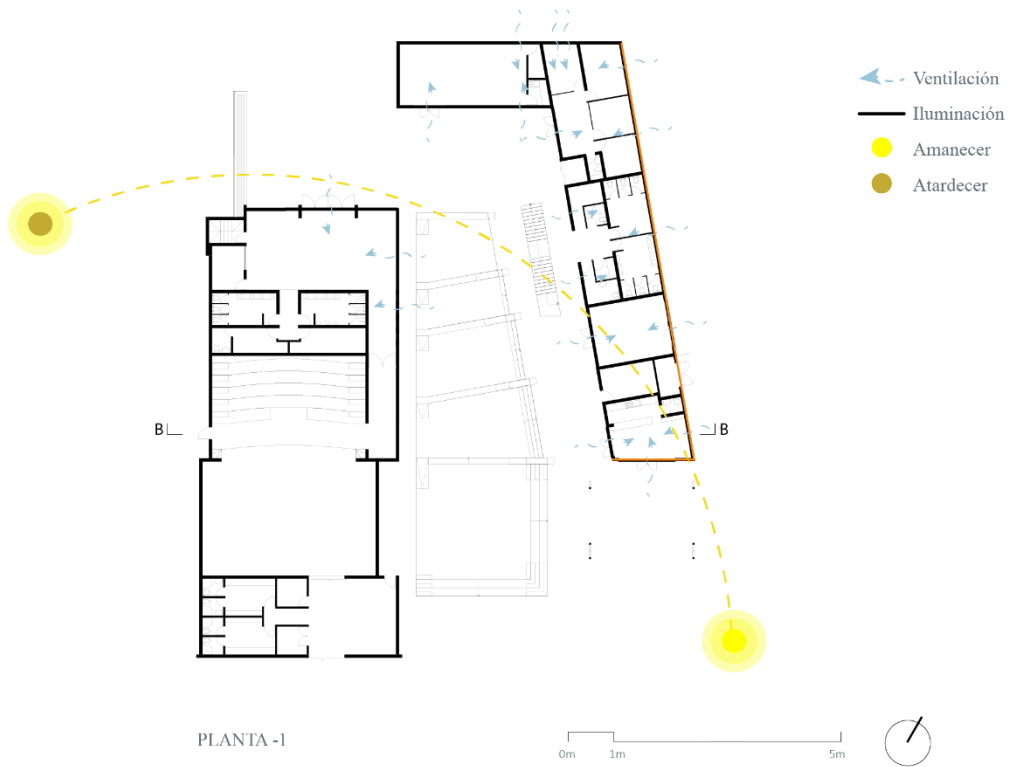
Análisis de iluminación y ventilación natural – Planta baja.
